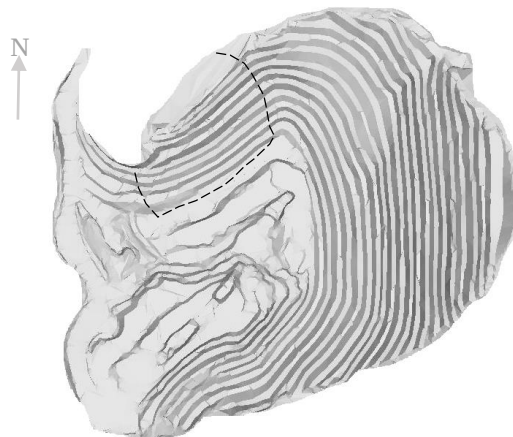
Vista em planta da cava João Burro e da ruptura ocorrida no talude oeste em agosto de 2014.
